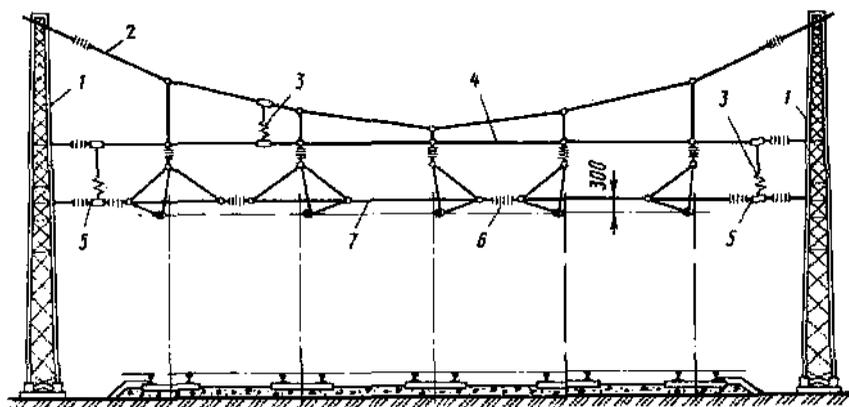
Устройство контактной сети на раздельном пункте: поперечный несущий трос 2, верхний 4 и нижний 7 фиксирующий тросы крепят к металлическим опорам 1; тросы друг с другом соединяют электрическими соединителями 3; в нижнем тросе устраивают нейтральные участки 5 и устанавливают секционирующие изоляторы 6
